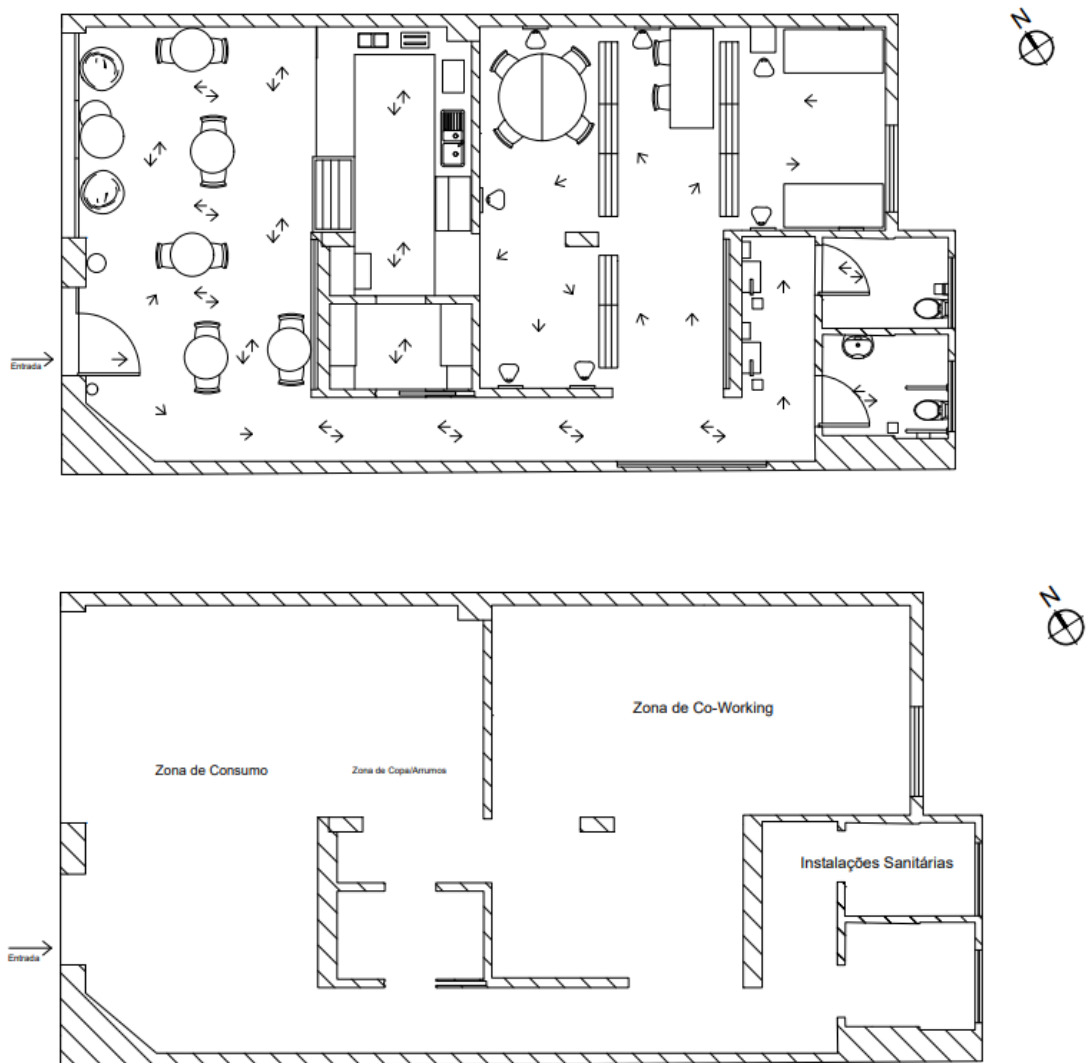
Planta de circulação e zonamento. Fonte: Rafael Costa
